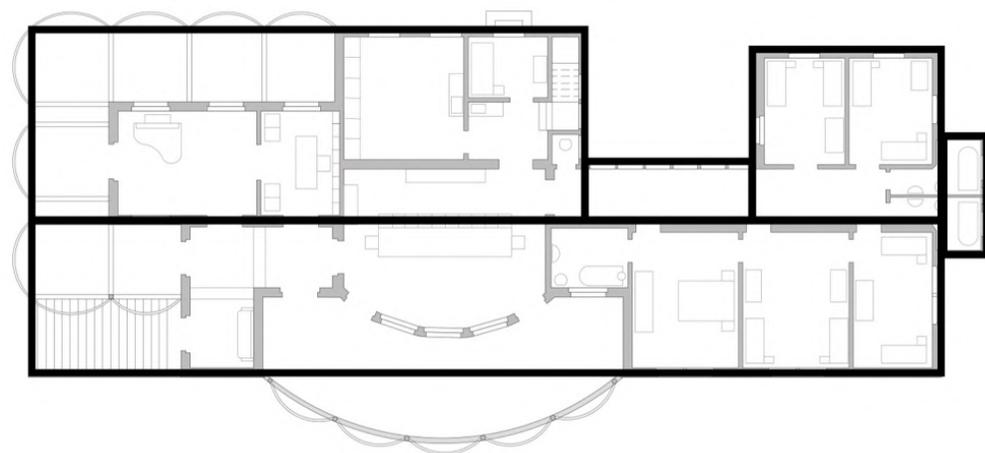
Divisões em planta da Villa Augusto Freire de Mattos Barreto. (1910)
